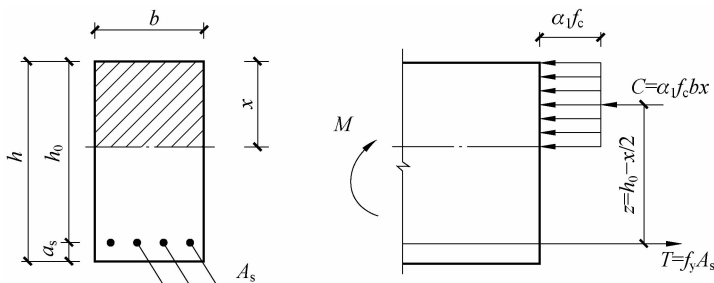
单筋矩形截面受弯构件正截面承载力计算简图
